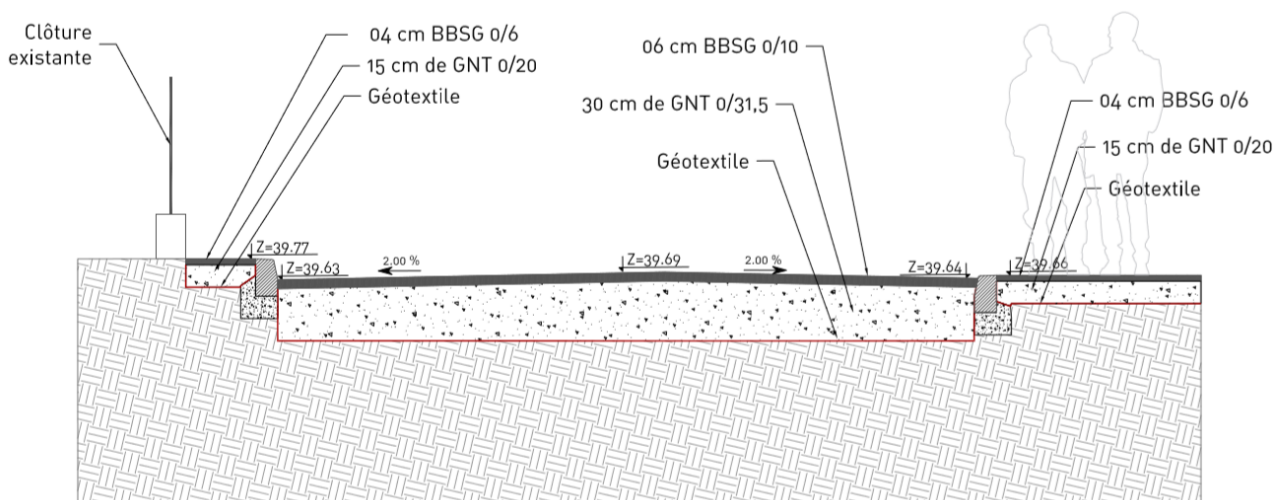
Coupe de détail voiries (Source : ATEVE Ingénierie)
